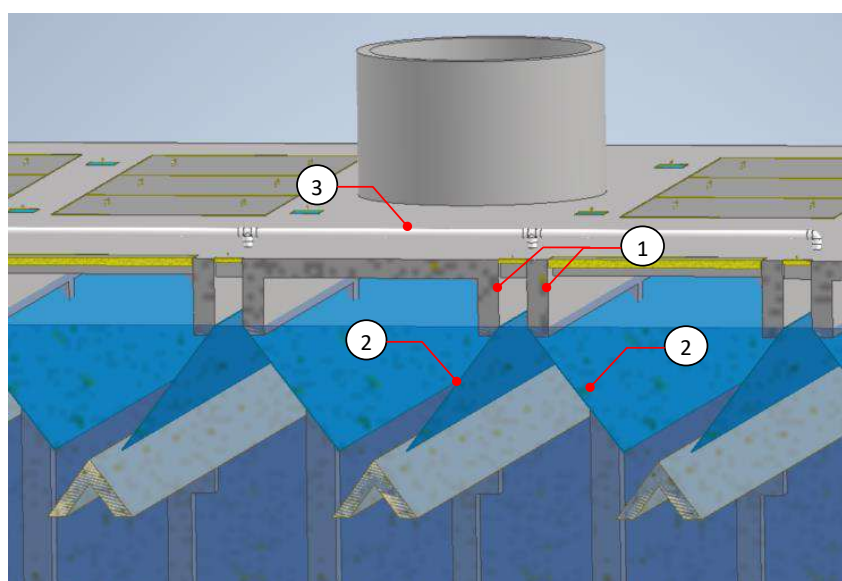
Detalhe da campânula do reator UASB da ETE Pinhal: Vigas de concreto (1); Cortinas de PRFV (2); Tubulação de coleta do biogás (3).
